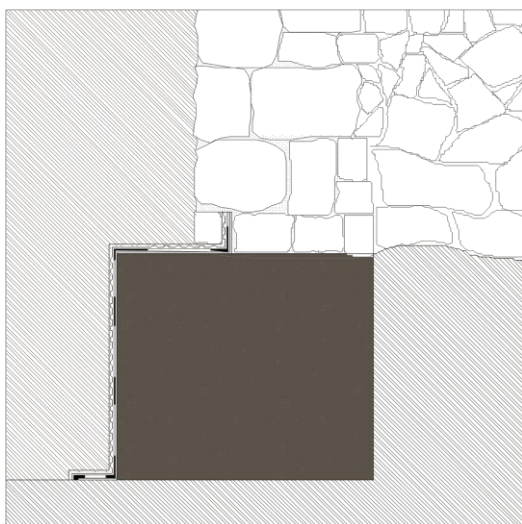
Detalle de la impermeabilización en la cimentación ejecutada.
